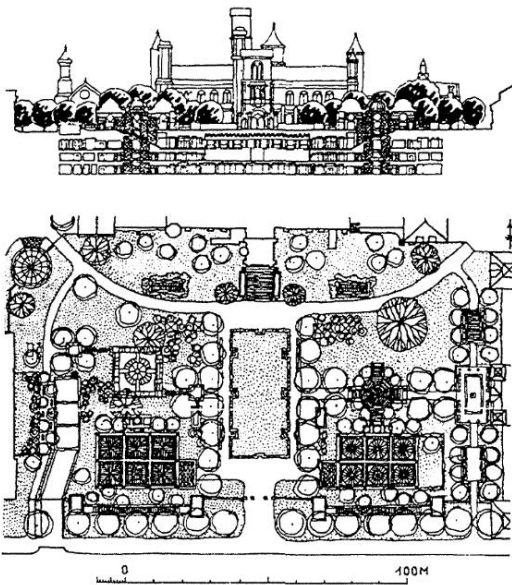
Сад на крыше музейных зданий Смитсоновского института в Вашингтоне. План и разрез
